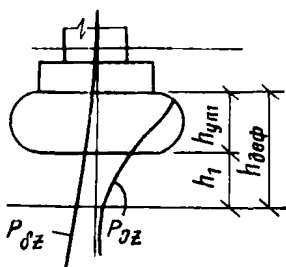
Схема к расчету возможных величин просадок фундаментов на просадочных грунтах с I типом грунтовых условий
